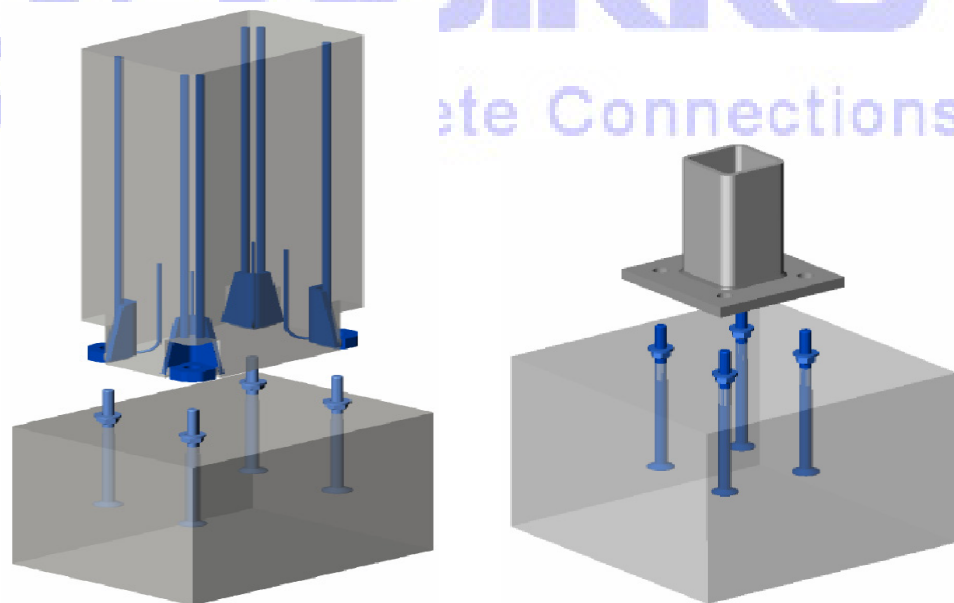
Ejemplos de conexión pilar prefabricado de hormigón y metálico.
